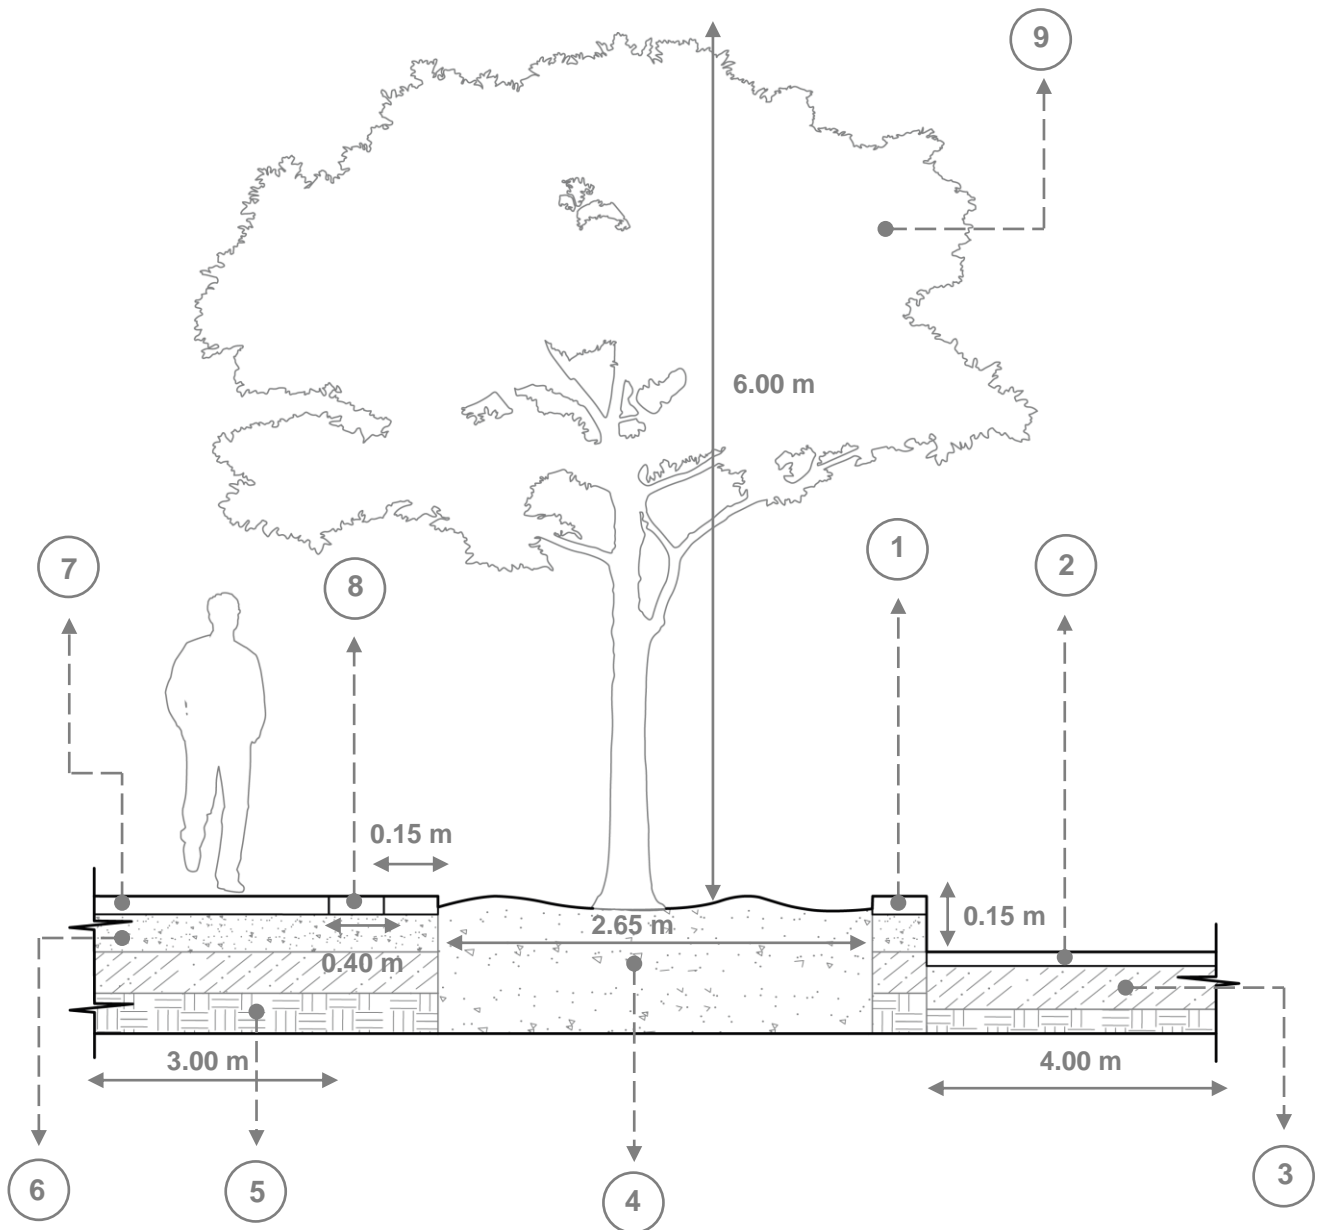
Detalle constructivo de ampliación de aceras con áreas verdes
